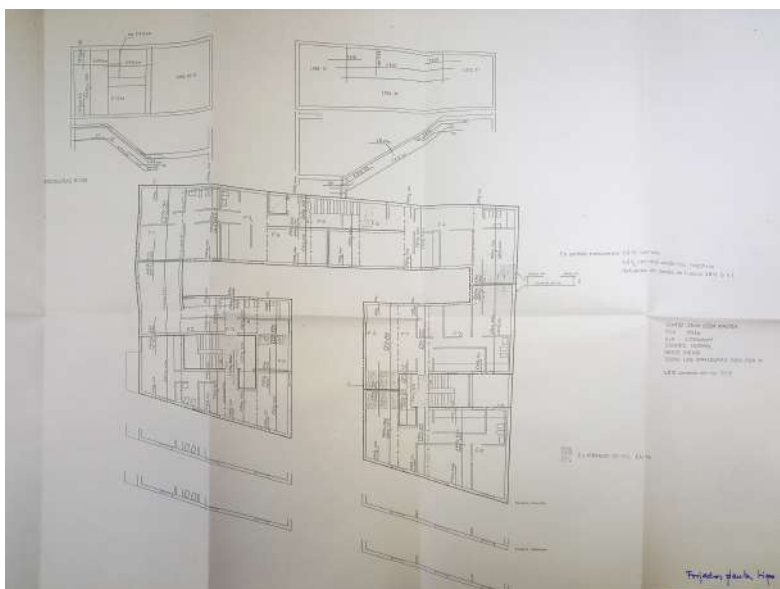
Plano de forjados de la planta tipo. Proyecto de ejecución.
